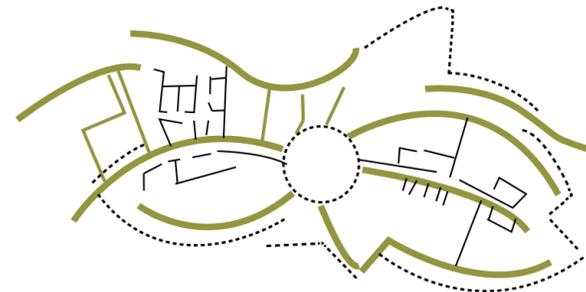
Esquema estructura centro de visitantes Van Dusen. Adaptado de (Mi moleskine arquitectónico, 2011)
